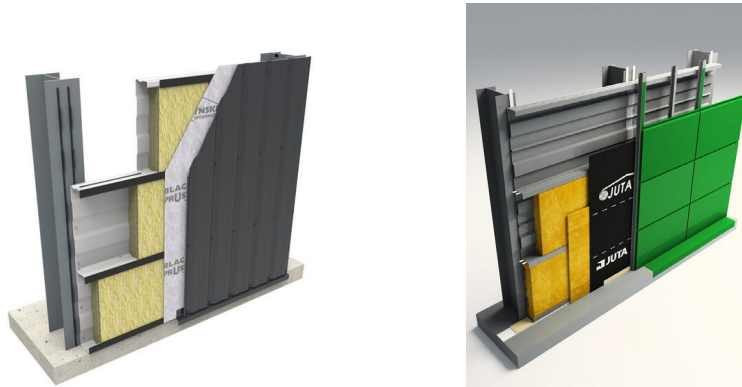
Огороджувальні конструкції із сандвіч - панелей або вентиляваних фасадів
